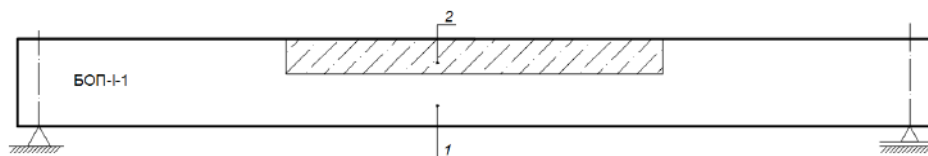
Схеми підсилення балок БОП-I: 1- дослідна балка; 2- залізобетонний вкладиш з пресованого бетону
